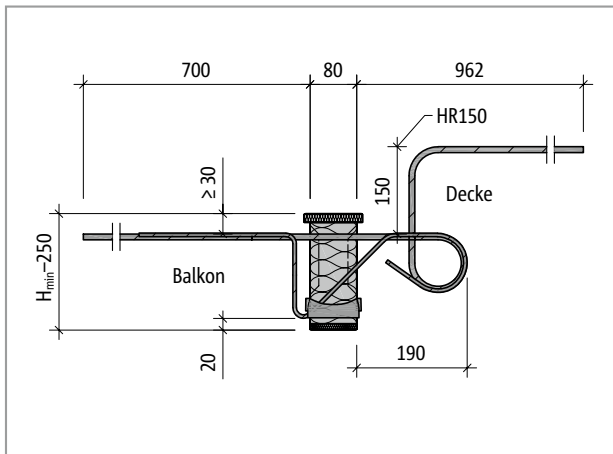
Schöck Isokorb® T Typ K-HV-M2: Produktschnitt
